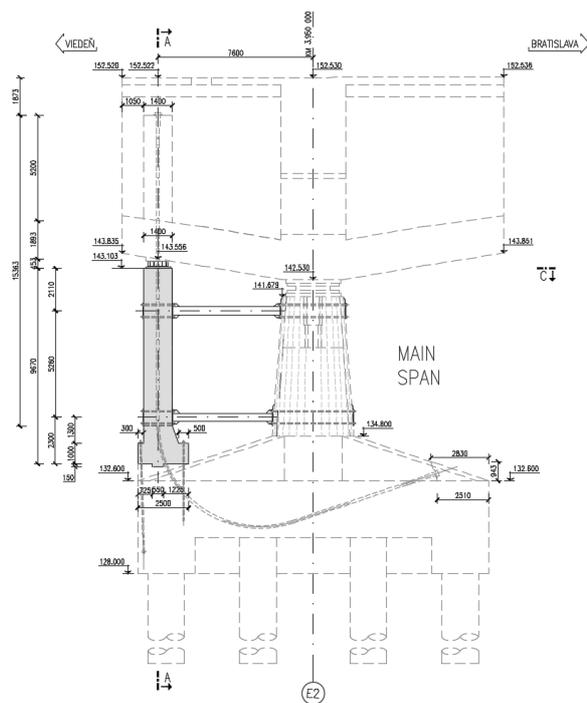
Vista lateral de una pila principal durante la construcción del tablero, dotada de pila provisional.
